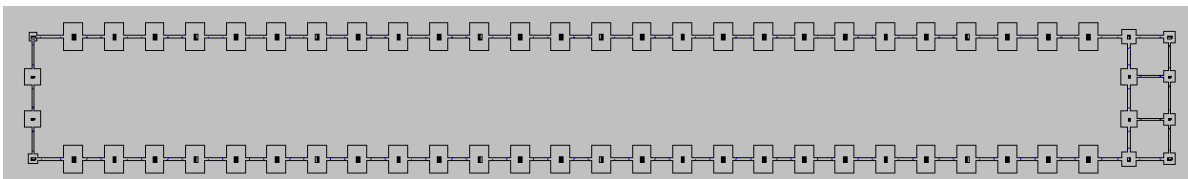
Distribución pilares y zapatas. Elaboración propia
